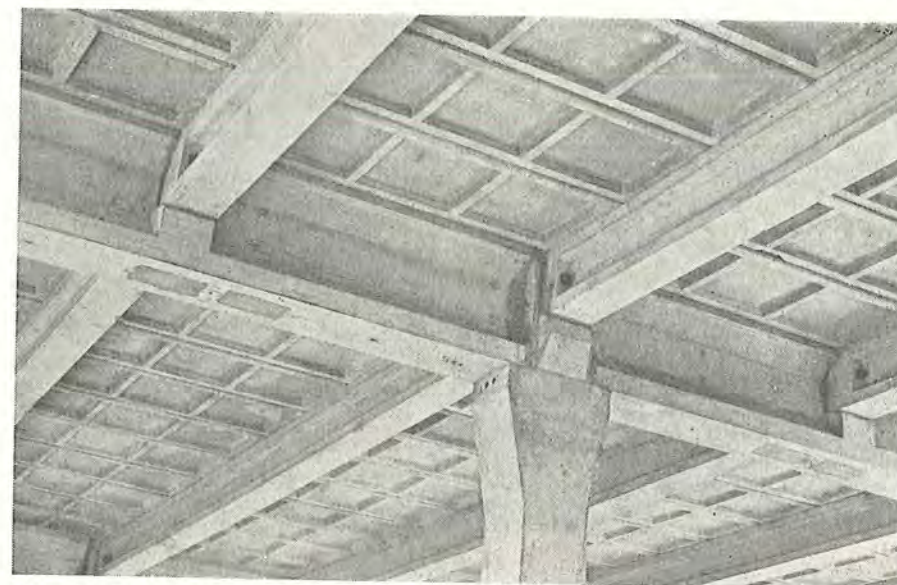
Disse prefabrikerede elementer er samlede med bolte og står ikke tilbage for stålkonstruktioner, hvad monteringshastigheden angår. (Hollandsk byggeplads).
